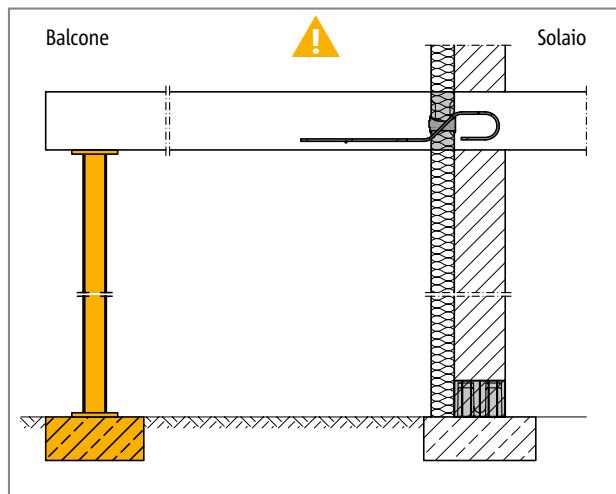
Schöck Isokorb® tipo QP, è necessario un sostegno continuo
